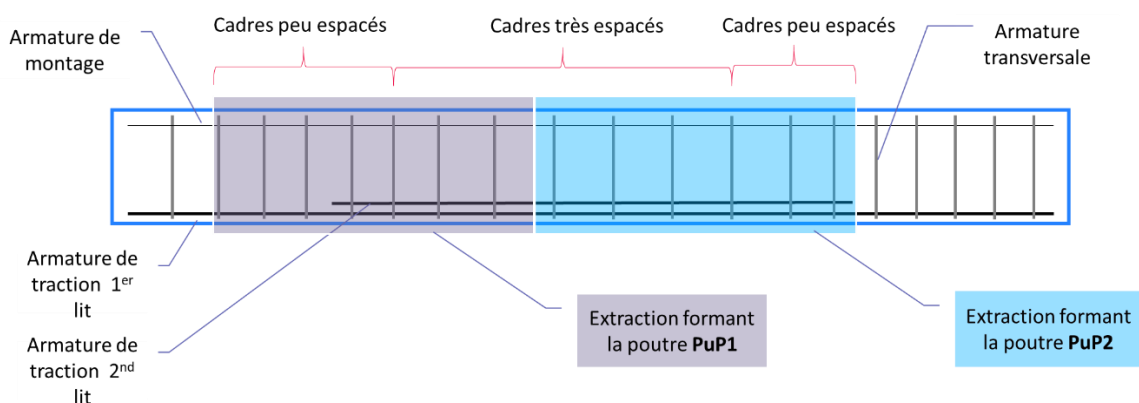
Hypothèse de situation des poutres PuP1 et PuP2 au sein de la poutre complète avant déconstruction
